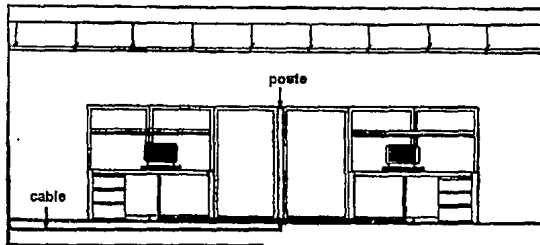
Cableado por piso UNDERFLOOR.
